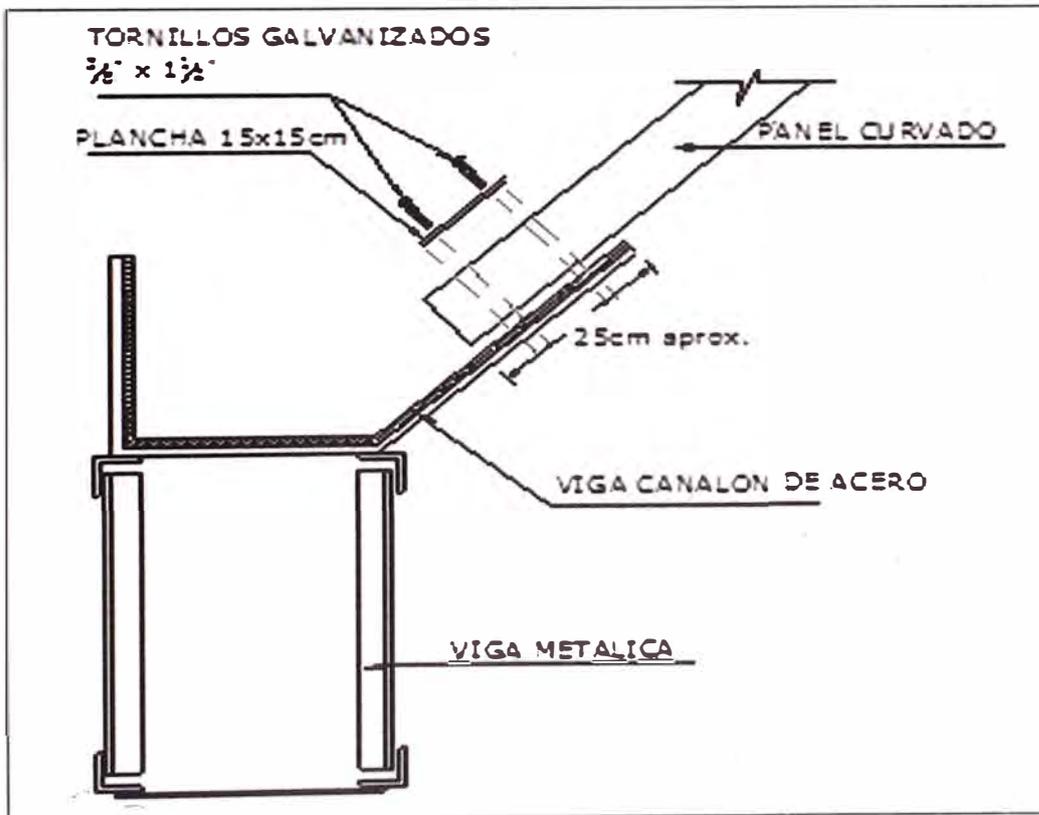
Anclaje en viga de acero (Referencia 3)
